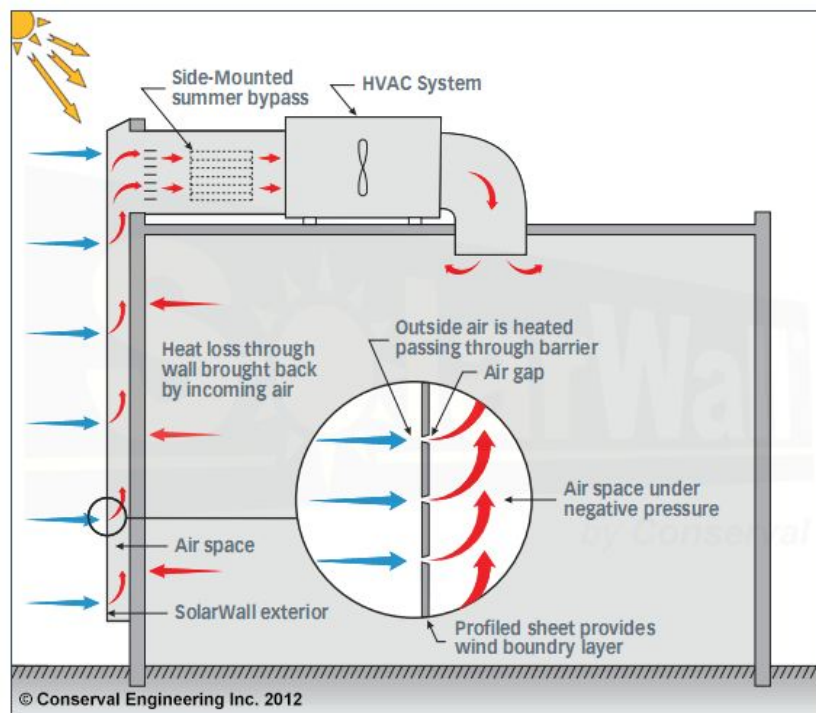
Sistema de calefacción por ventilación (Solar Wall)
